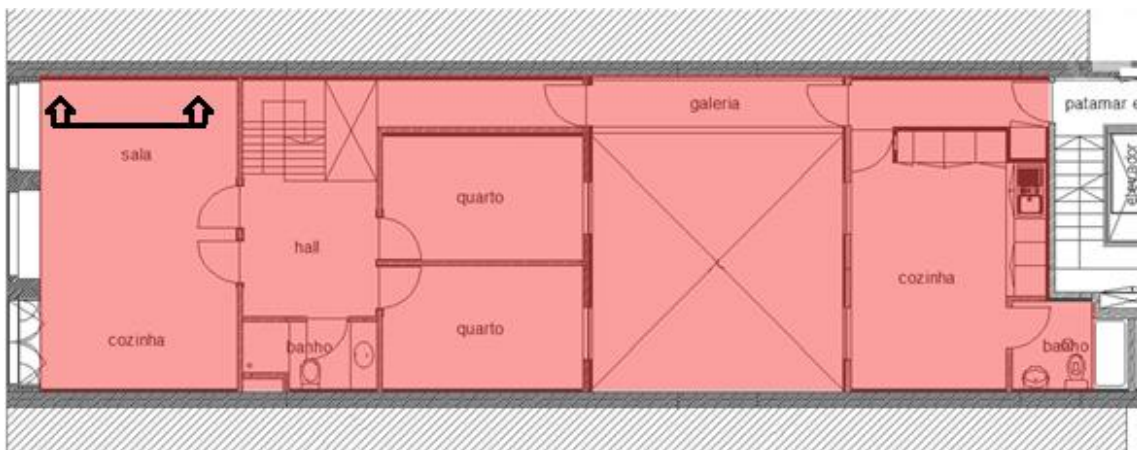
Marcação da zona de corte da laje na planta (Adaptado das peças desenhadas do Edifício do Caso de Estudo)
